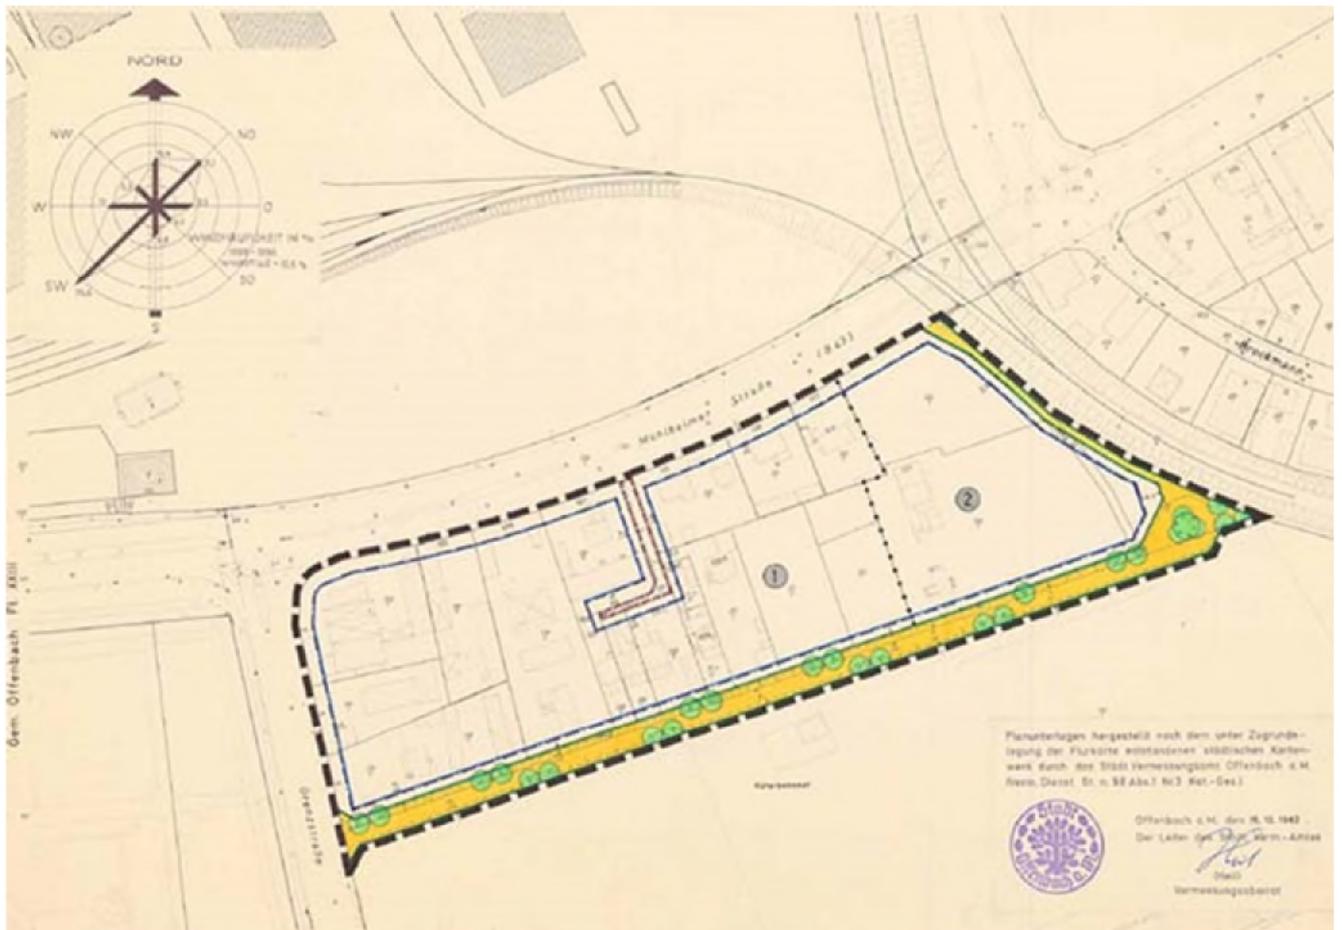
Bebauungsplan Nr. 516 „Mülheimer Straße / Grenzstraße“
